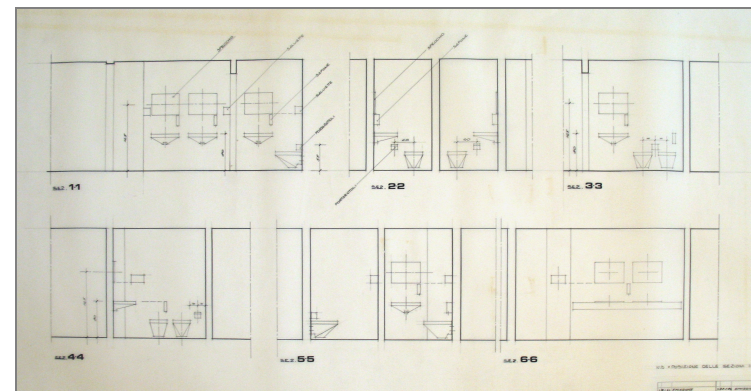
posizionamento accessori servizi - (fonte CSAC – stralcio tav. 135, archivio n. 384-4)
